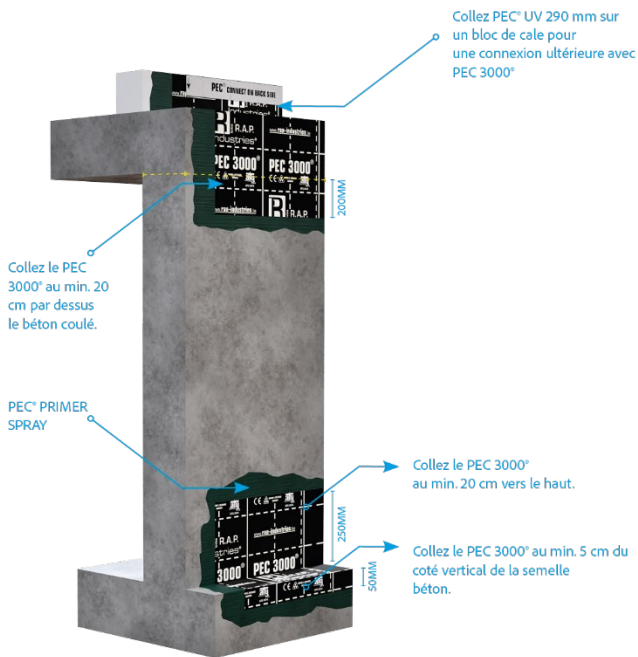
Application de PEC 3000® sur un mur de sous-sol en béton coulé ou préfabriqué
